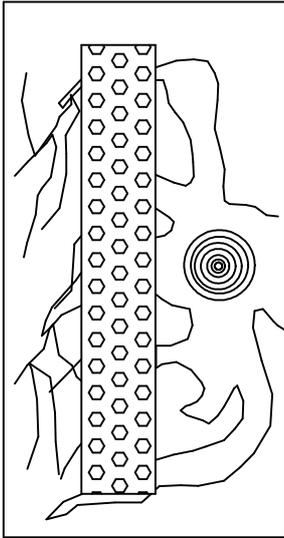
Protezione dell'albero attraverso la delimitazione dell'area minima di rispetto in aree parco.
